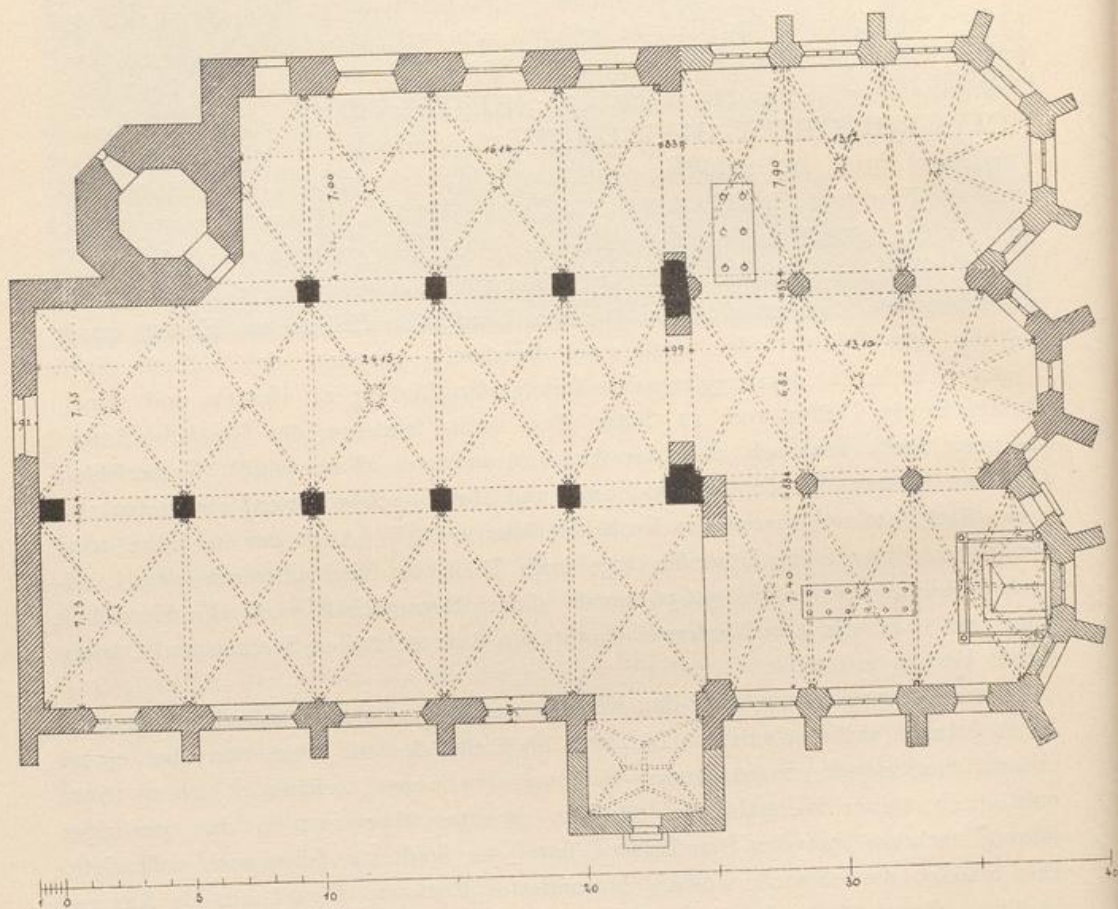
Grundriss der Pfarrkirche zu Butzbach.
